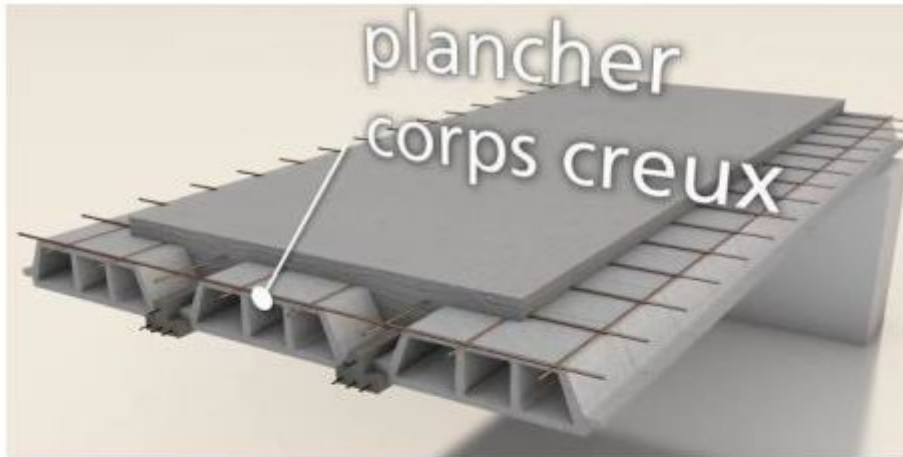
Les éléments principaux d'un plancher à corps creux.
